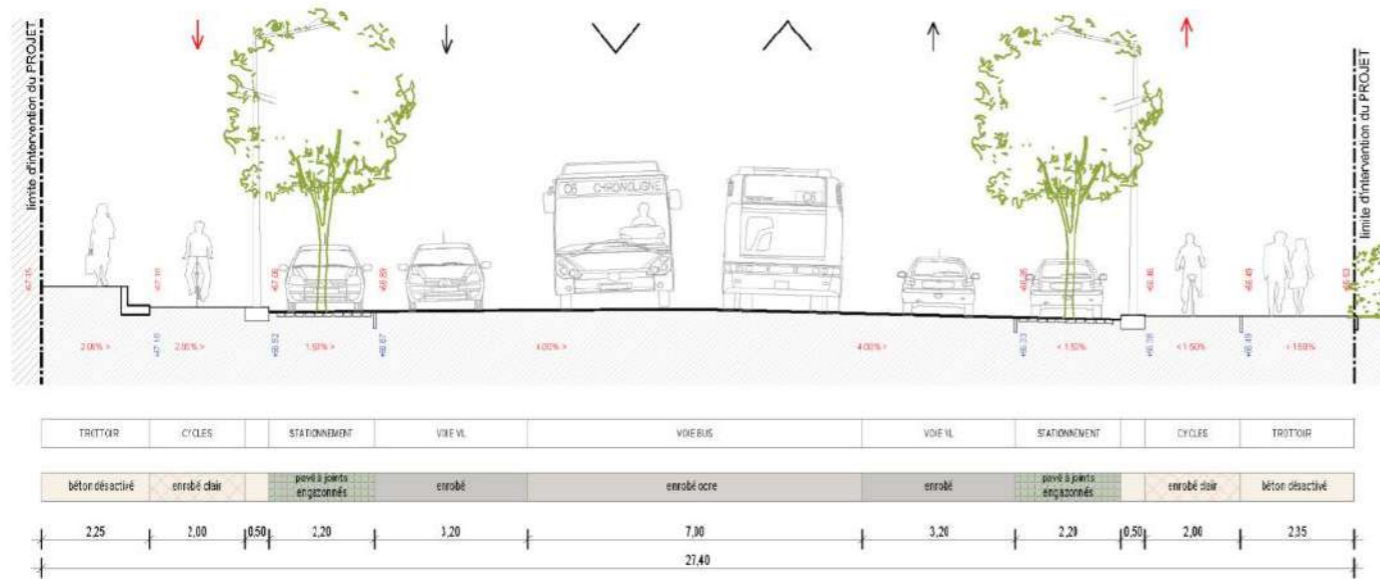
Profil futur de l'Avenue Bollée - Sud
